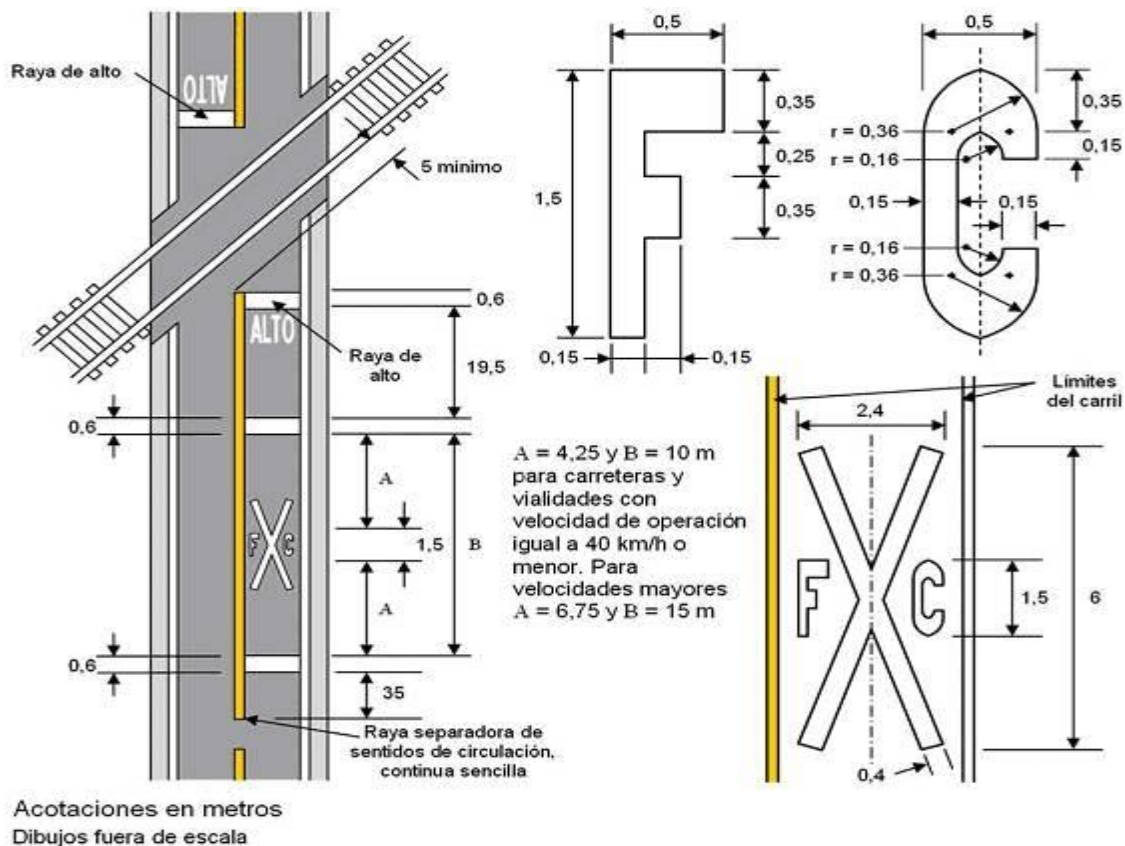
Marcas para cruce de FERROCARRIL (M-8)
